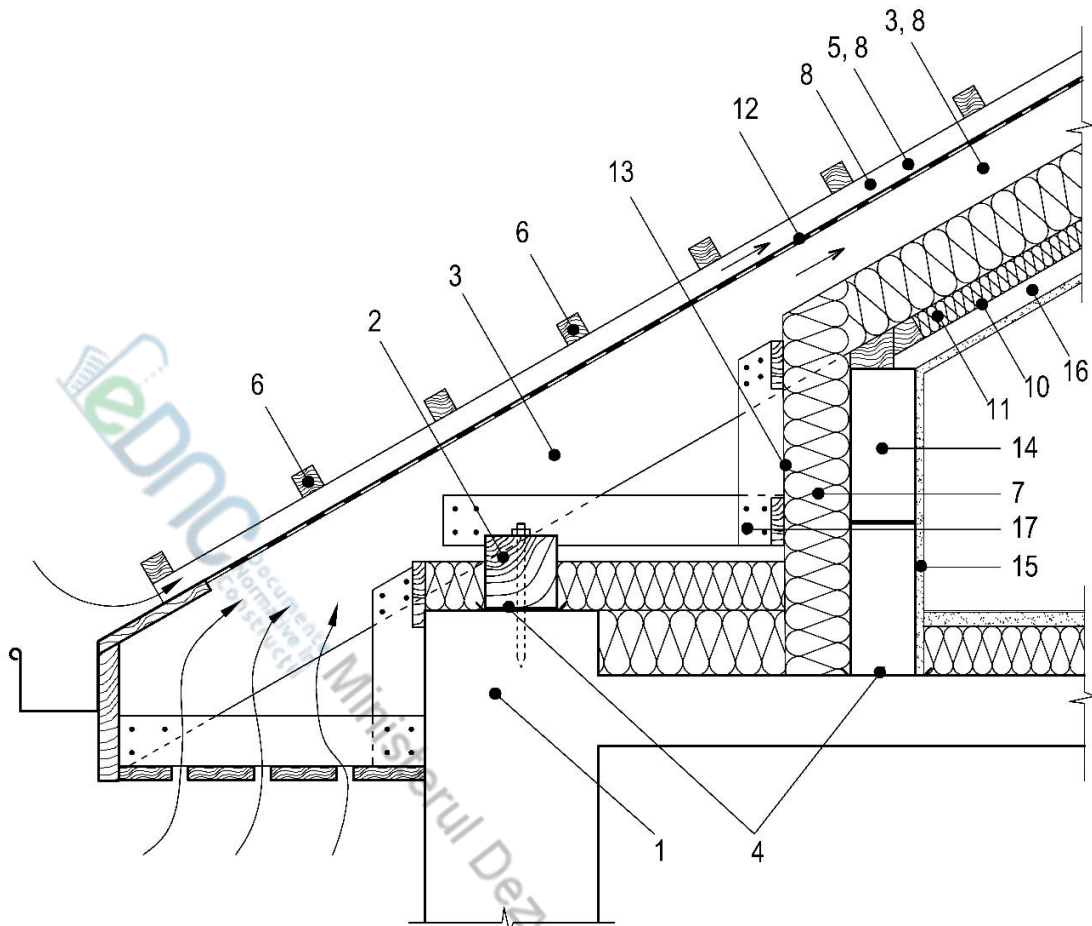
Стена из легких конструкций с теплоизоляцией (D) наклонное верхнее перекрытие с теплоизолирующим слоем расположенном частично под стропила и частично между стропилами
